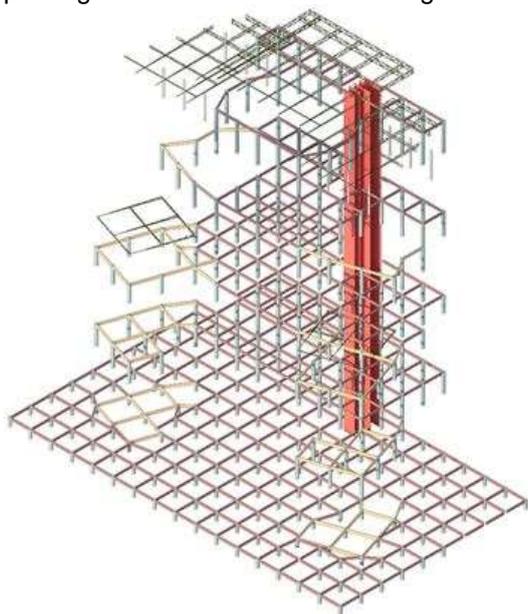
Zoning pada lantai 1 sampai lantai 4
